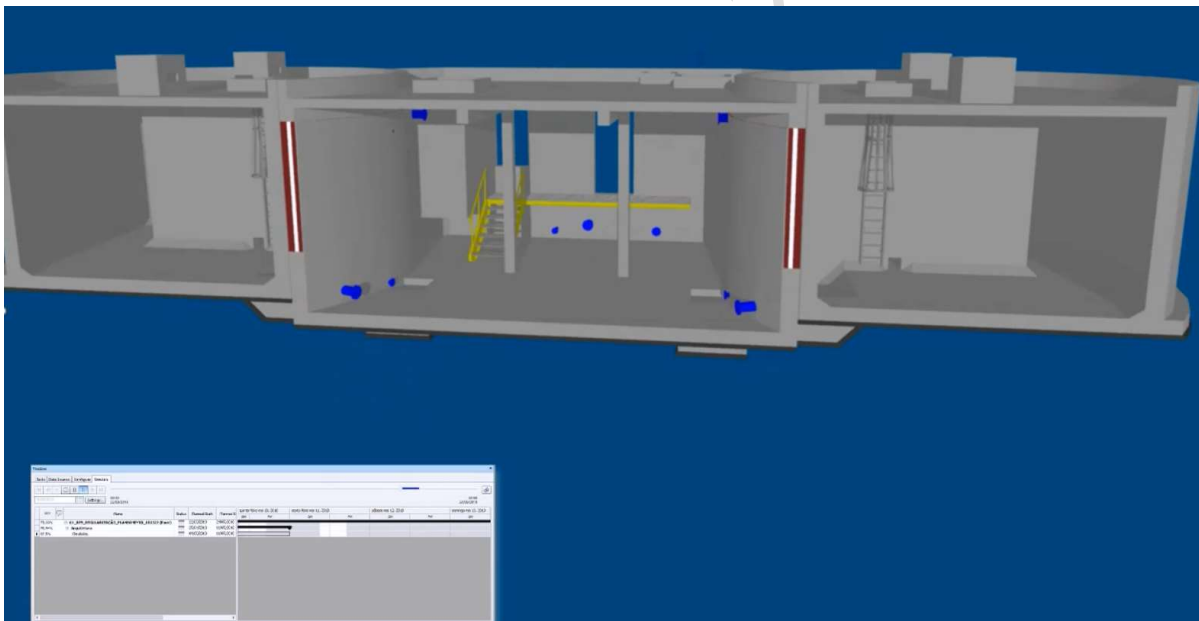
Planeamento de execução da obra (Durante a fase de execução)
